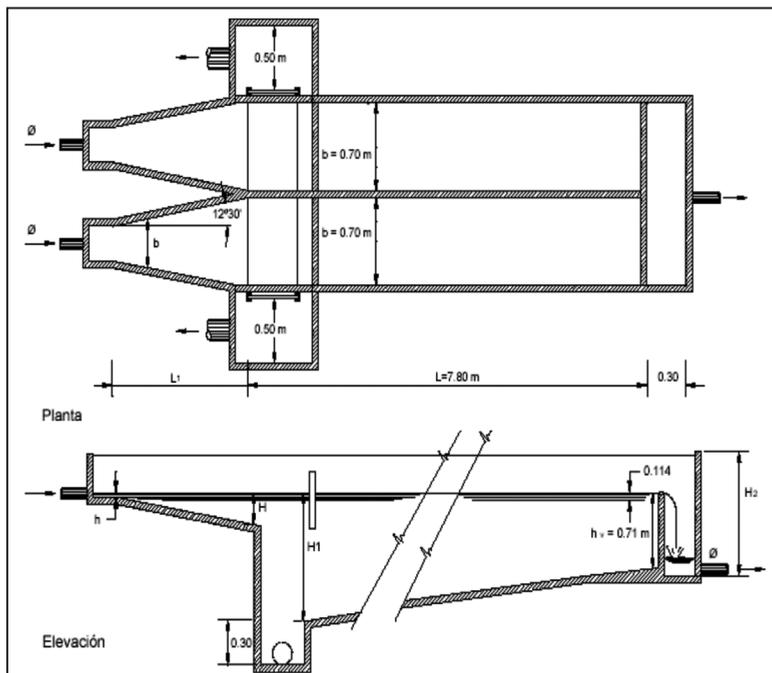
Desarenador y desengrasador. Planta y corte.
